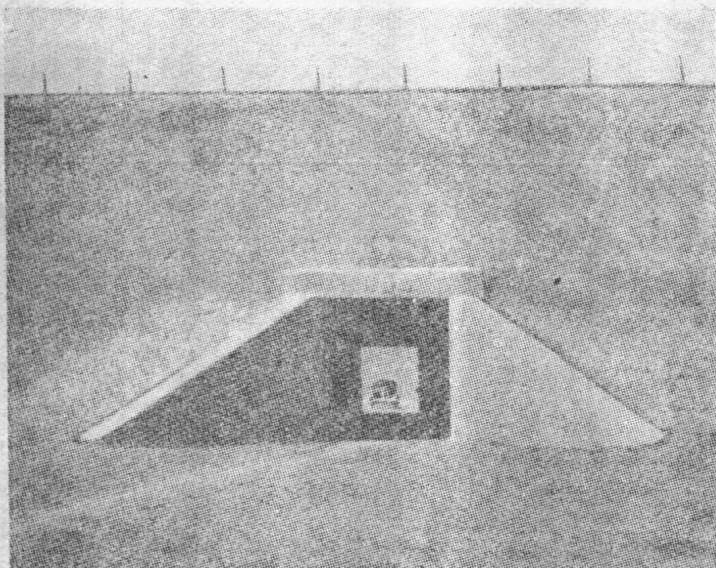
有鋼筋混凝土板梁平頂的混凝土涵洞
